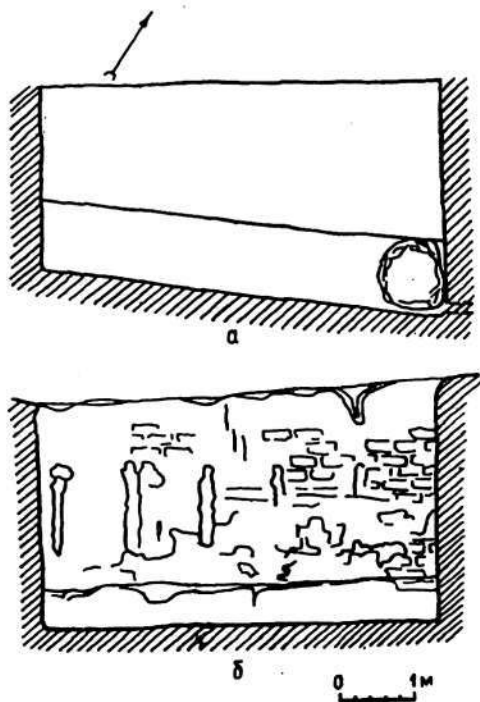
Помещение 9: а — план; б — фасад южной стены.
